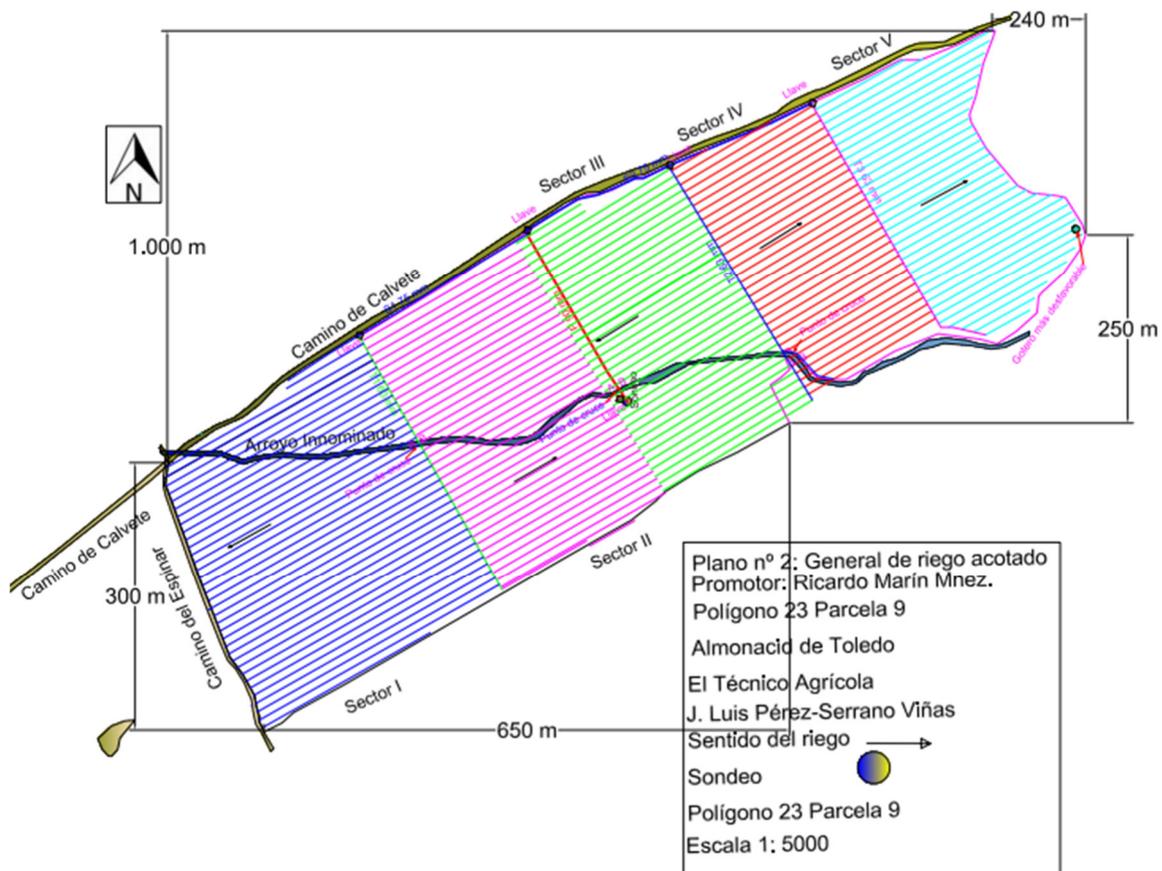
plano con los sectores de riego, la distribución de tuberías y los puntos de corte de las mismas con el arroyo (fuente documento ambiental). Las líneas coloreadas orientadas en dirección Suroeste Noreste son las tuberías portagoteros, superficiales. El resto están enterradas.
